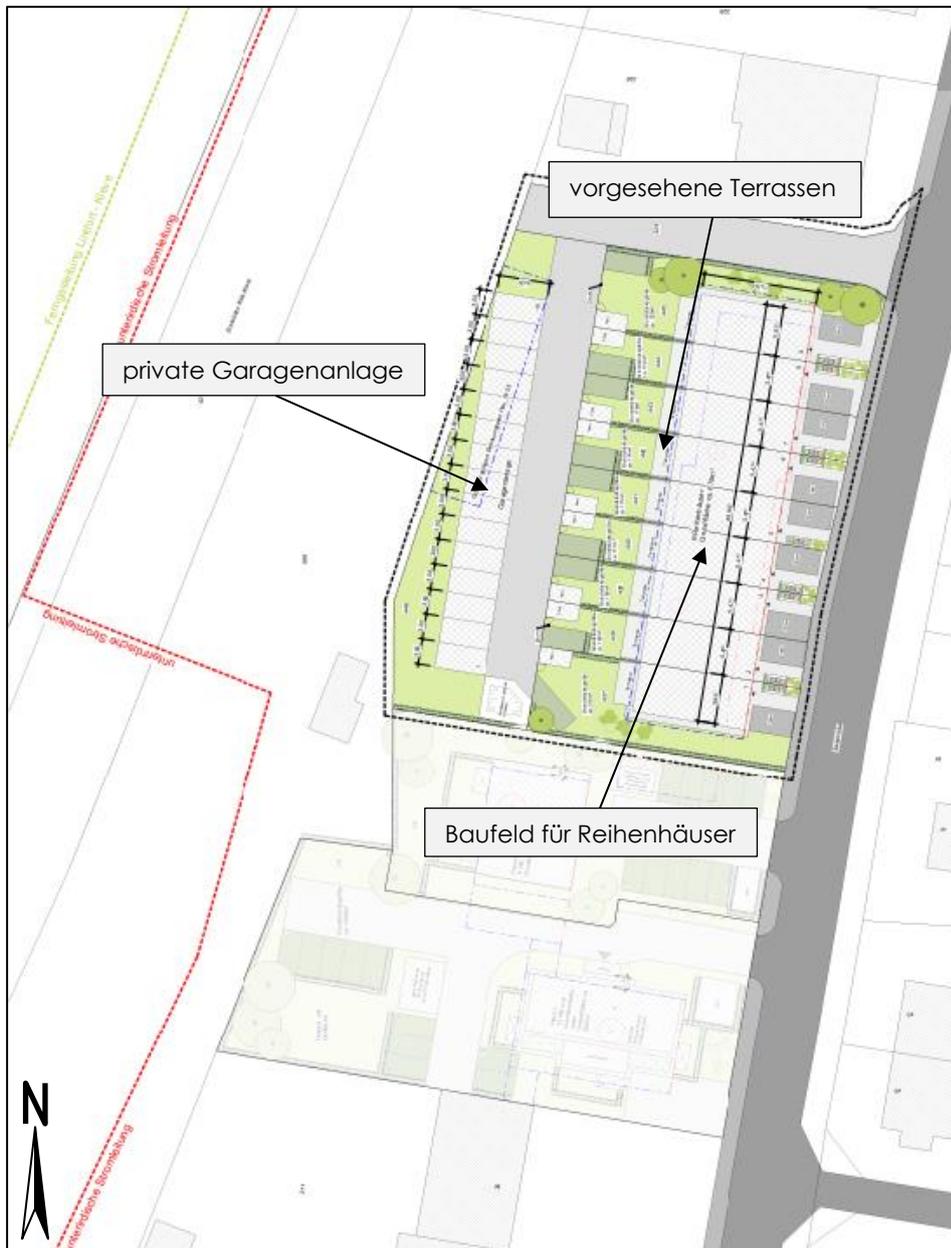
Lageplan mit Darstellung des Vorhabens
